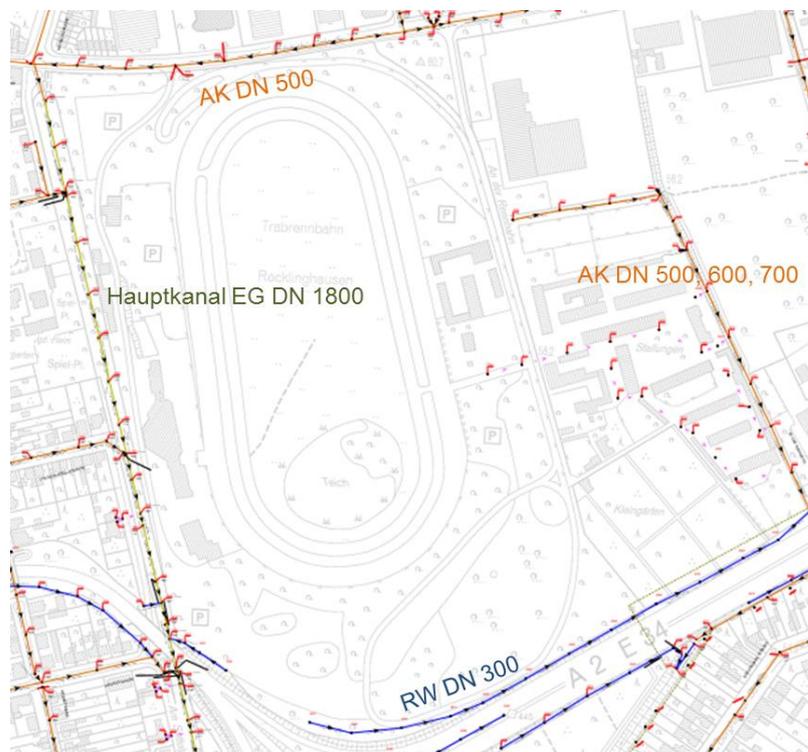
Ausschnitt Lageplan Kanalbestand (zur Verfügung gestellt durch Stadtentwässerung Recklinghausen (Sachgebiet 62/41), Stand: 29.01.2020)
